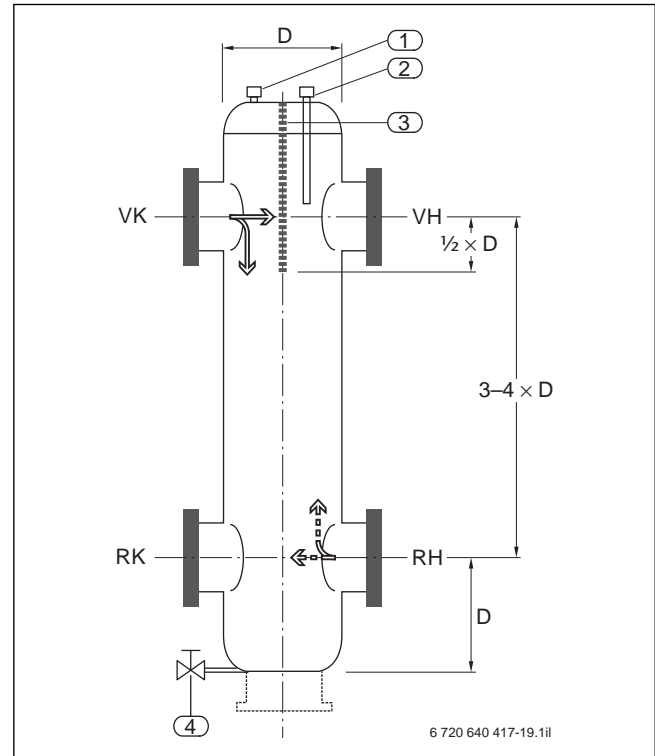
Prinzipskizze einer hydraulischen Ausgleichsleitung
